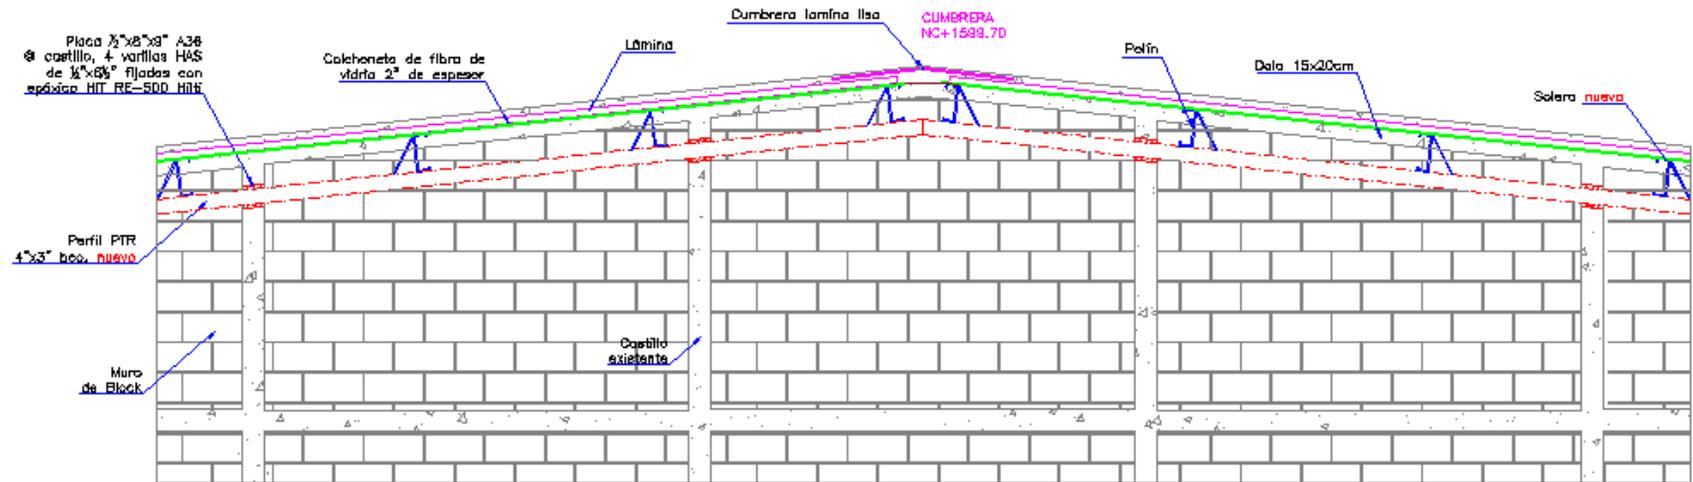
Detalle de apoyo de estructura metálica sobre muro de mampostería confinada.
